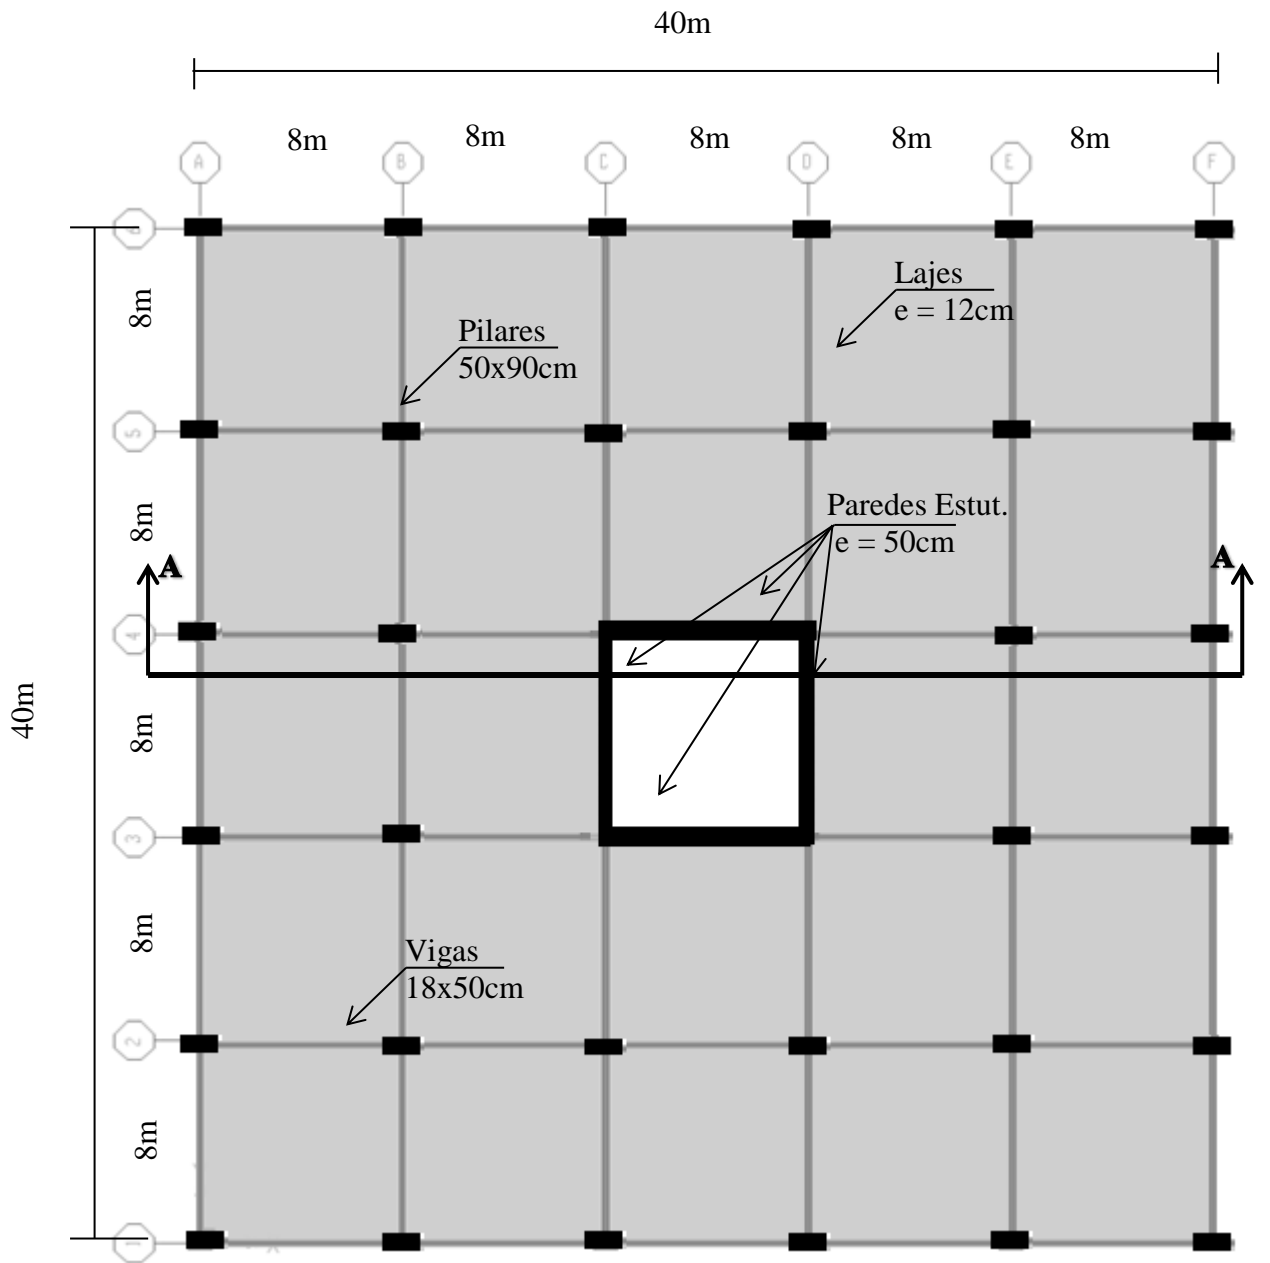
Visualização em planta do pavimento tipo do edifício.
